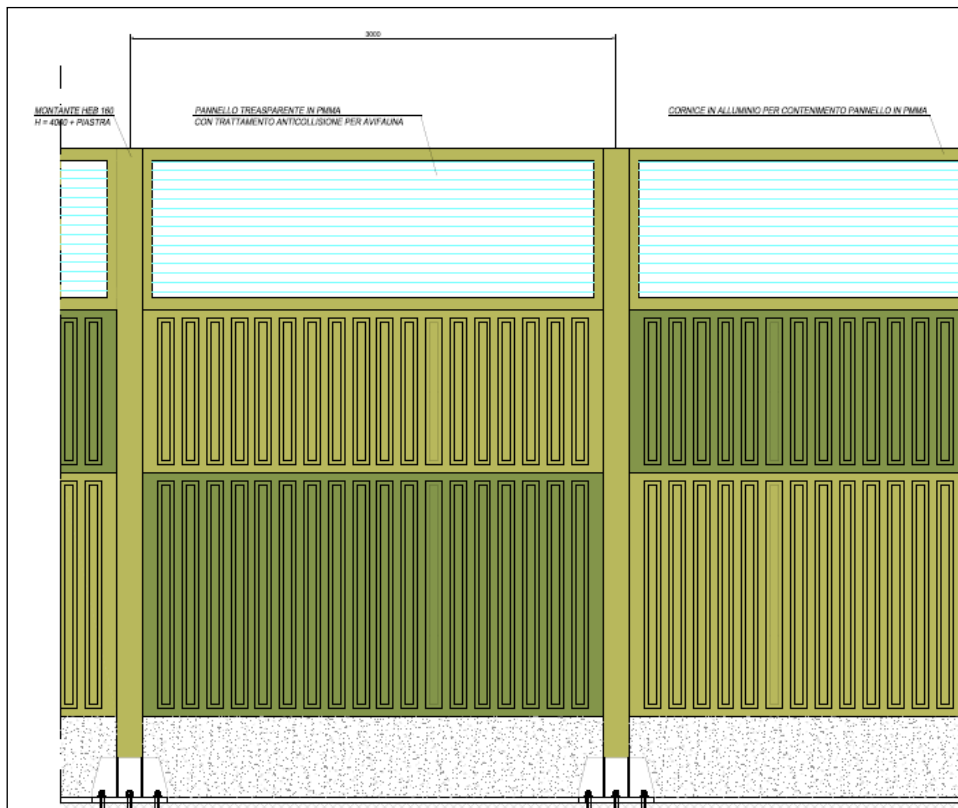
PROSPETTO TIPO - BARRIERA H. 4 M
